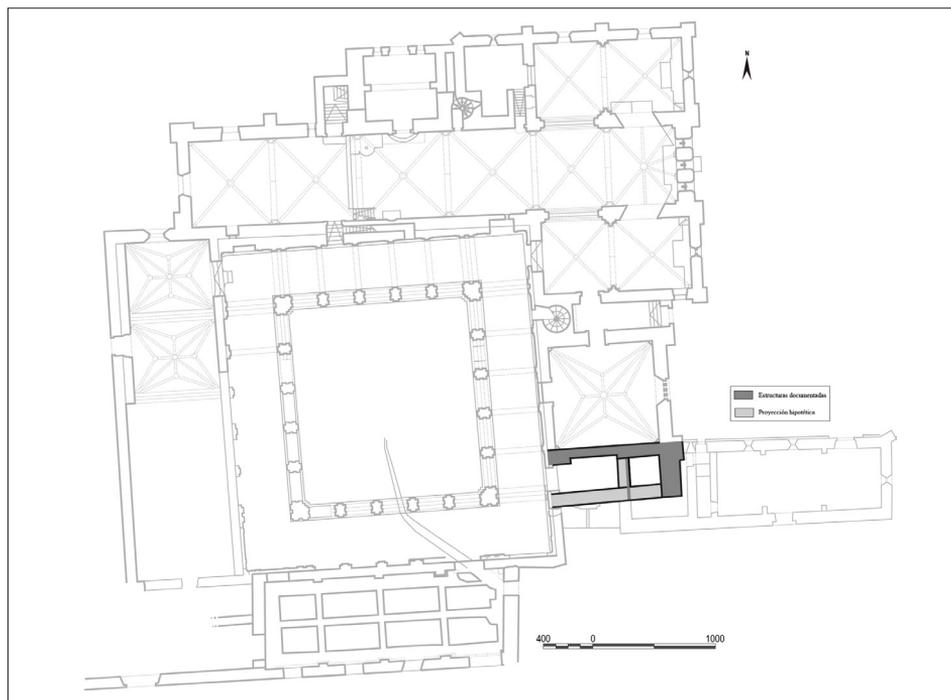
Indicios de una primera fase constructiva asociada a la etapa medieval y reconstrucción hipotética de su planta.
